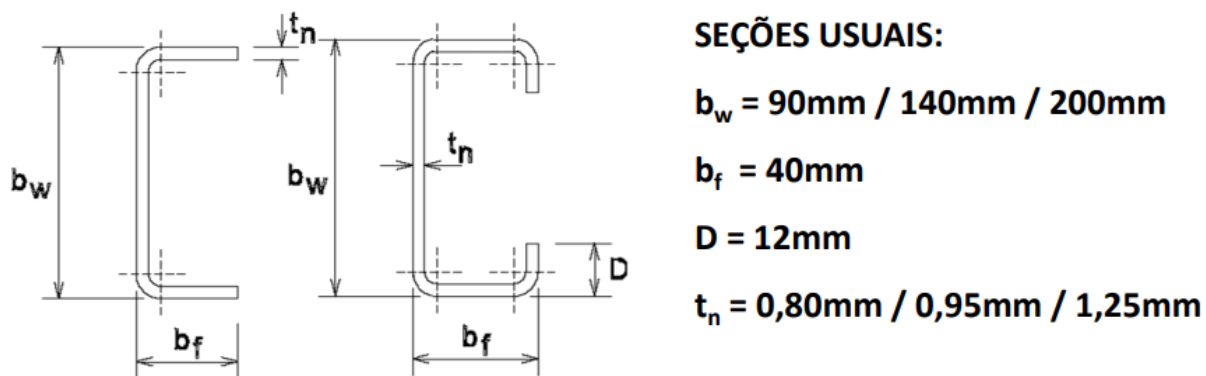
Dimensões usuais para telhado em *Steel Frame*.
